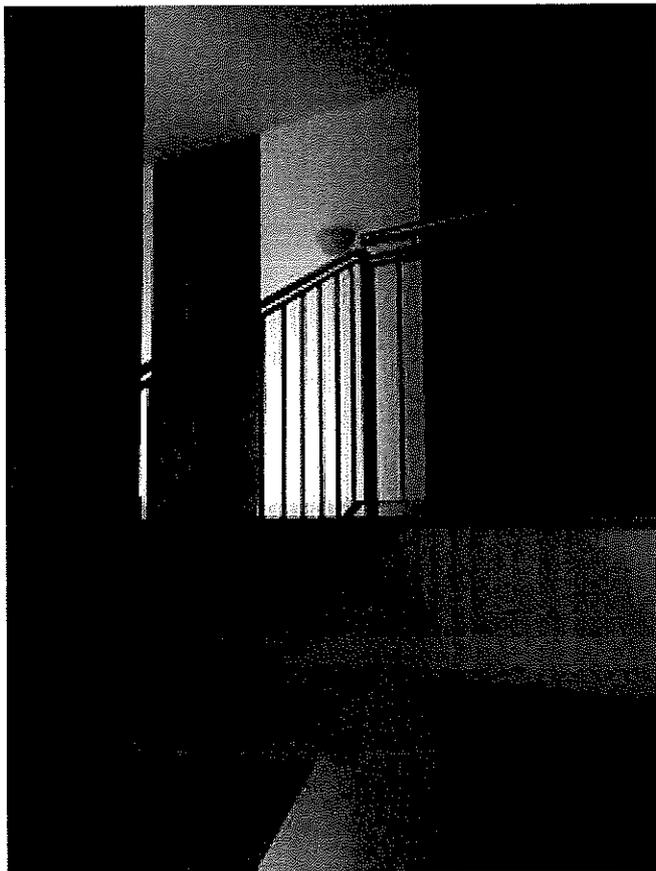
/17 – particolare del vano scale, il garage e la cantina in fondo con la porta di accesso
